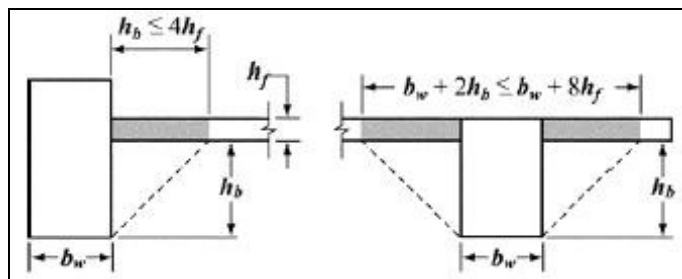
Norma ACI 318-05 Fig. R13.2.4. Porción de Losa Colaborante en Viga.
